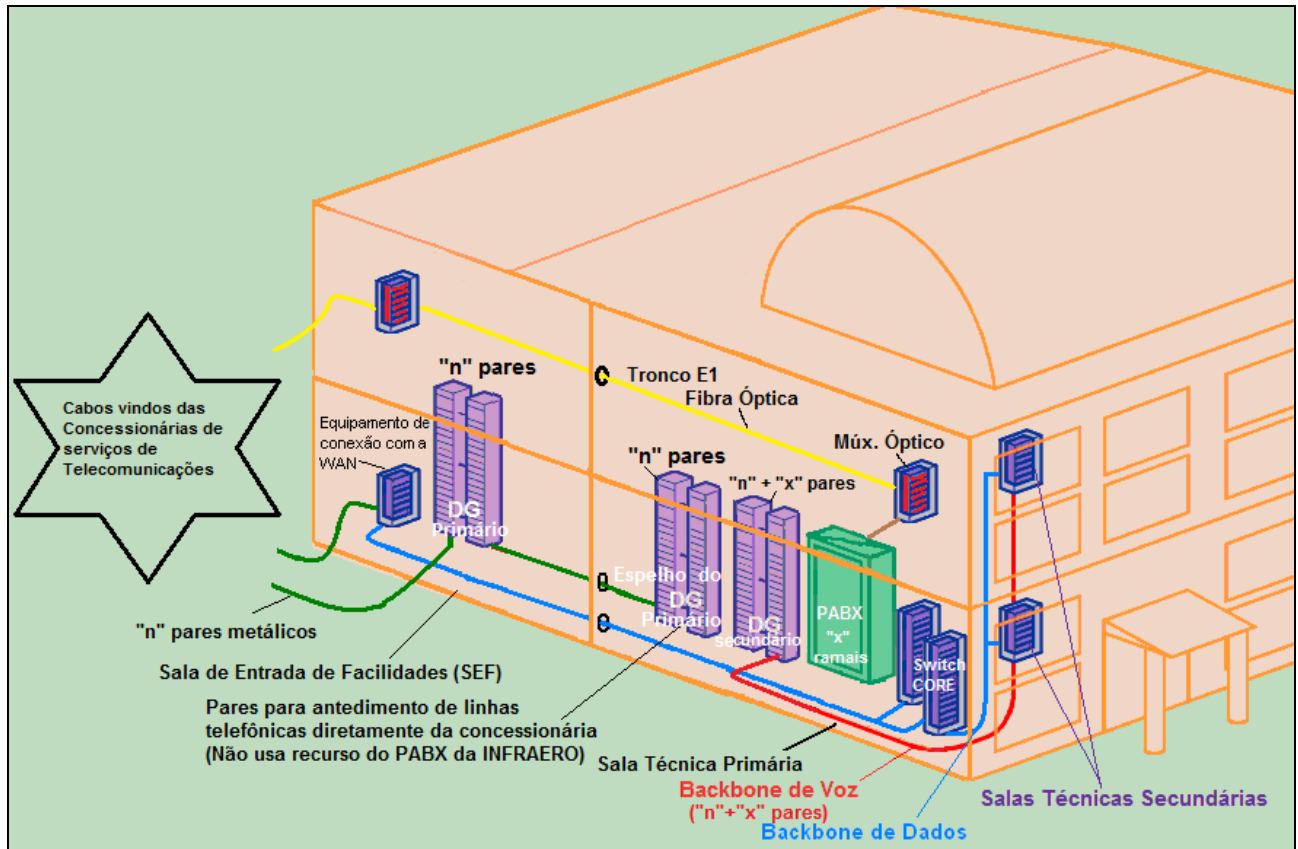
Exemplo de Layout de Sala Entrada de Facilidades.
